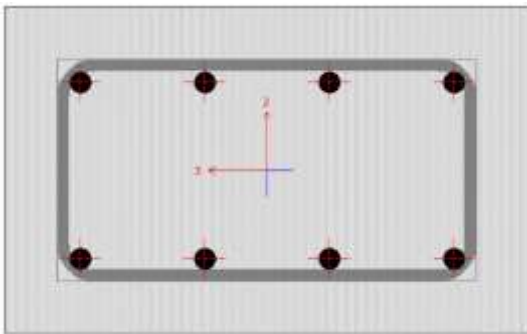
Concreto Armado, sección de columna C-1 (0.40x0.25)
